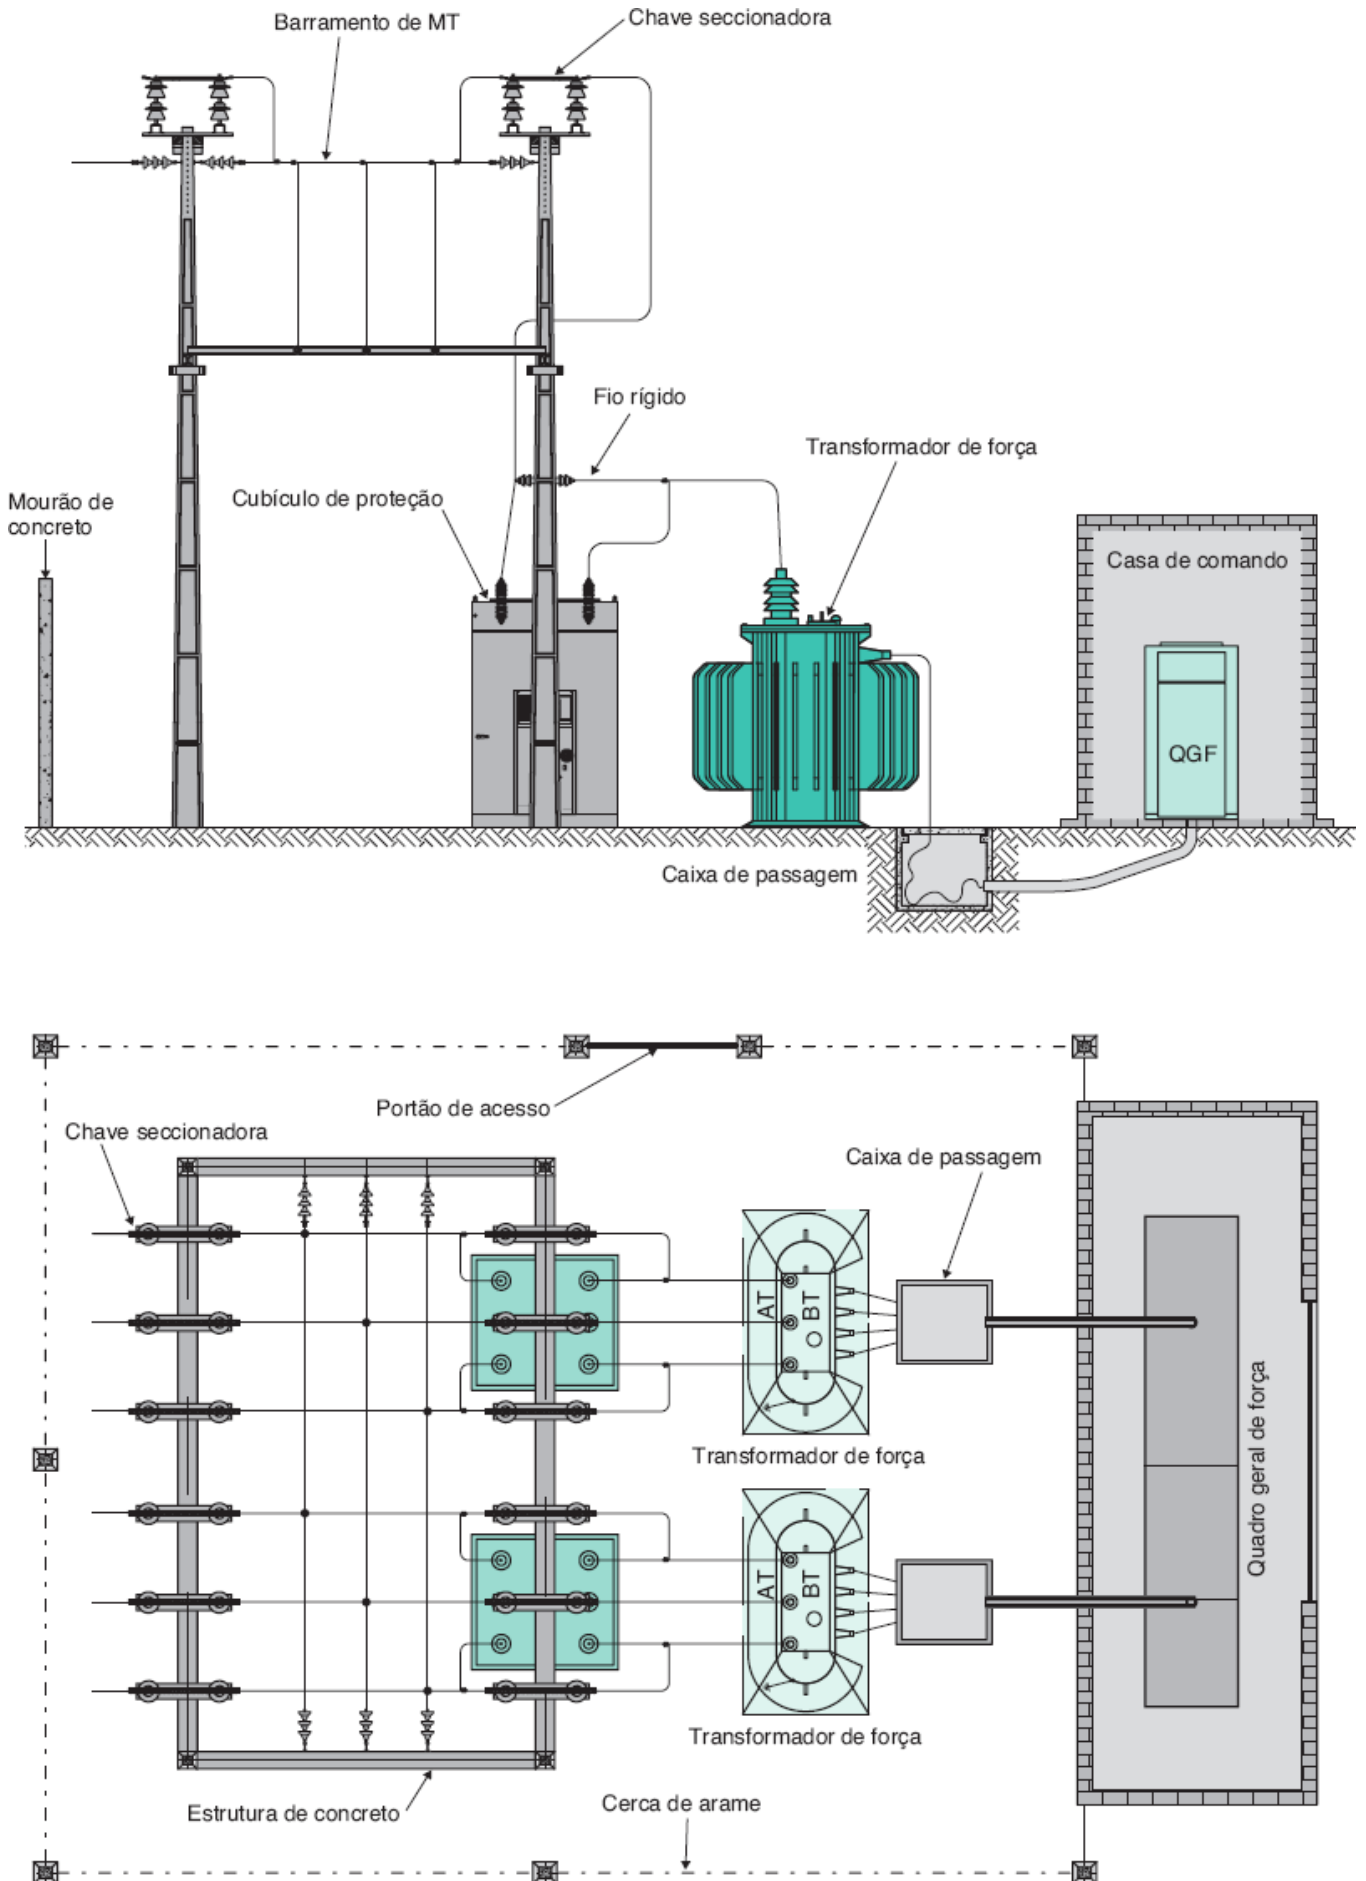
Vistas frontal e superior de uma subestação de instalação exterior no nível do solo.
